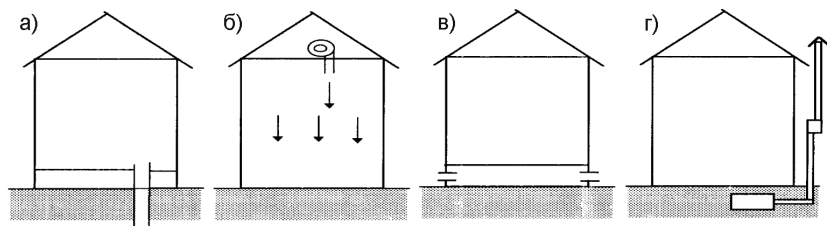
Схемы по снижению содержания радона в воздухе жилых помещений: герметизация подпольных перекрытий (изоляция) (а); создание повышенного давления внутри помещения (б); подпольная вентиляция (в); подпольное уменьшение давления (г)
